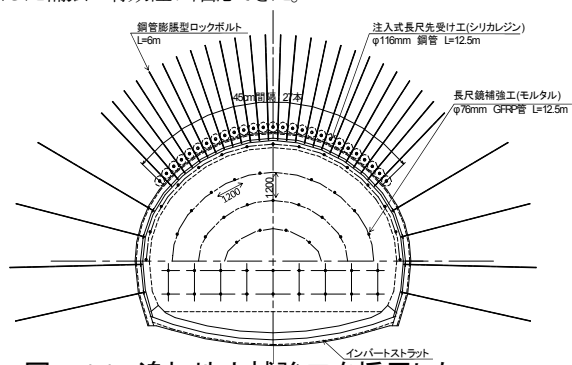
追加地山補強工を採用した施工パターン図(横断面図)
